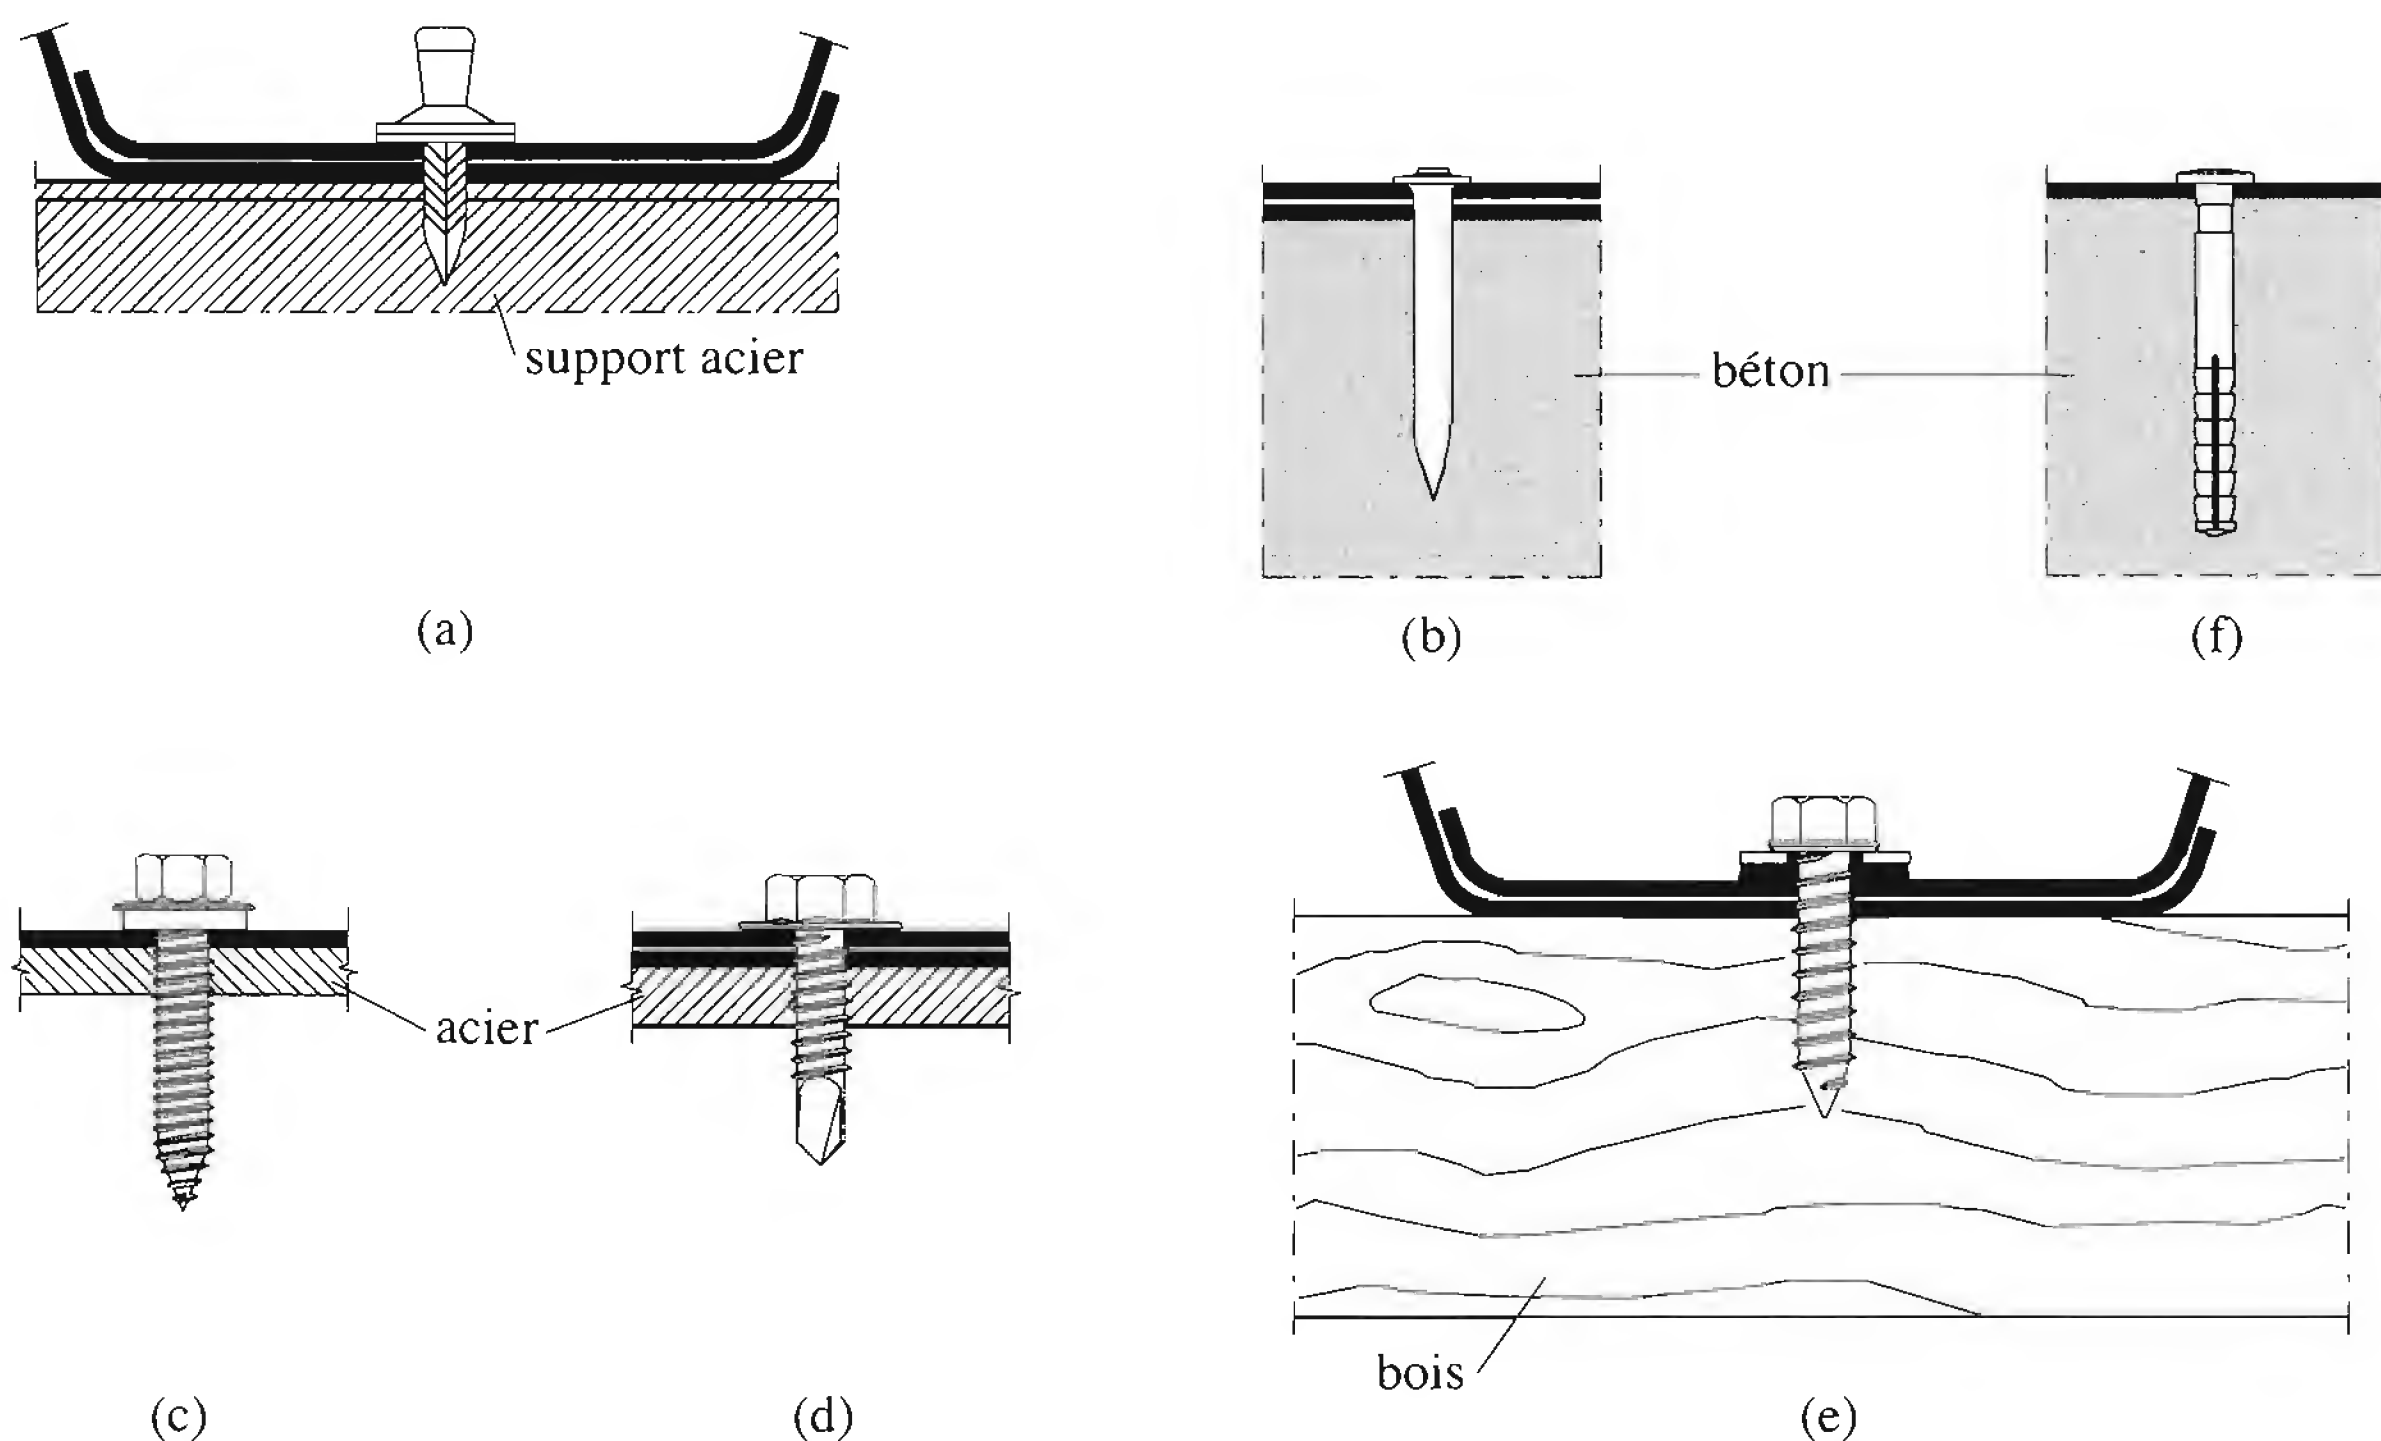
Exemples d'assemblages de tôle profilée.
